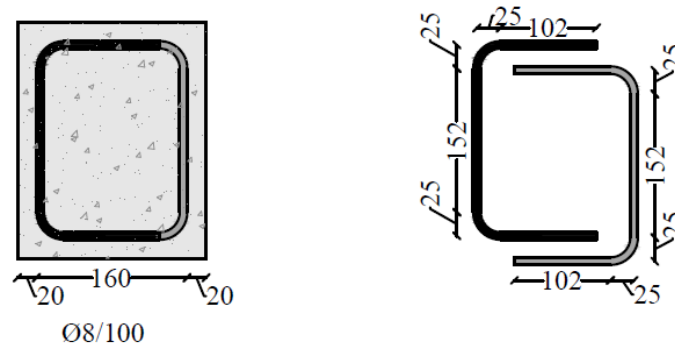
Disposición armadura de cortante de GRFP. Ensayo armadura pasiva
